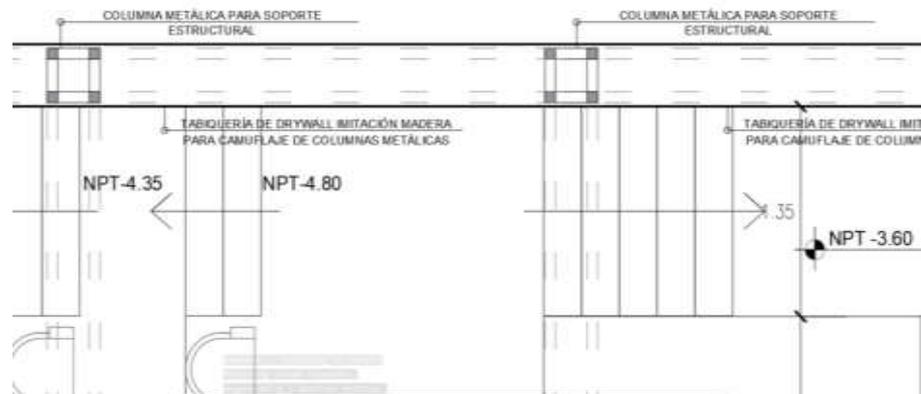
Detalle en planta estructura auditorio, fuente: elaboración propia.
